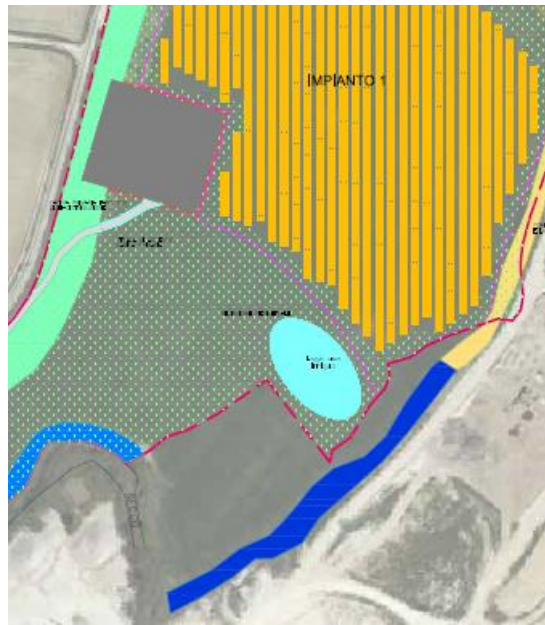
/5 Stralcio planimetria progetto mitigazione verde, con indicazione del laghetto in progetto
